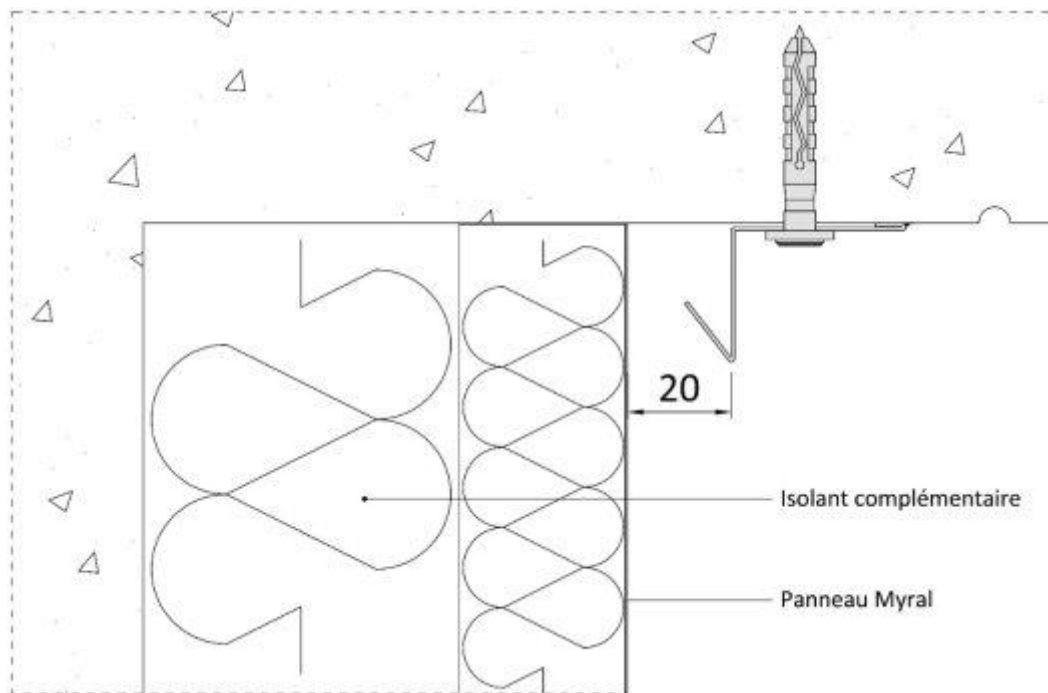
Haut de façade – Pose en vêture (coupe verticale)
